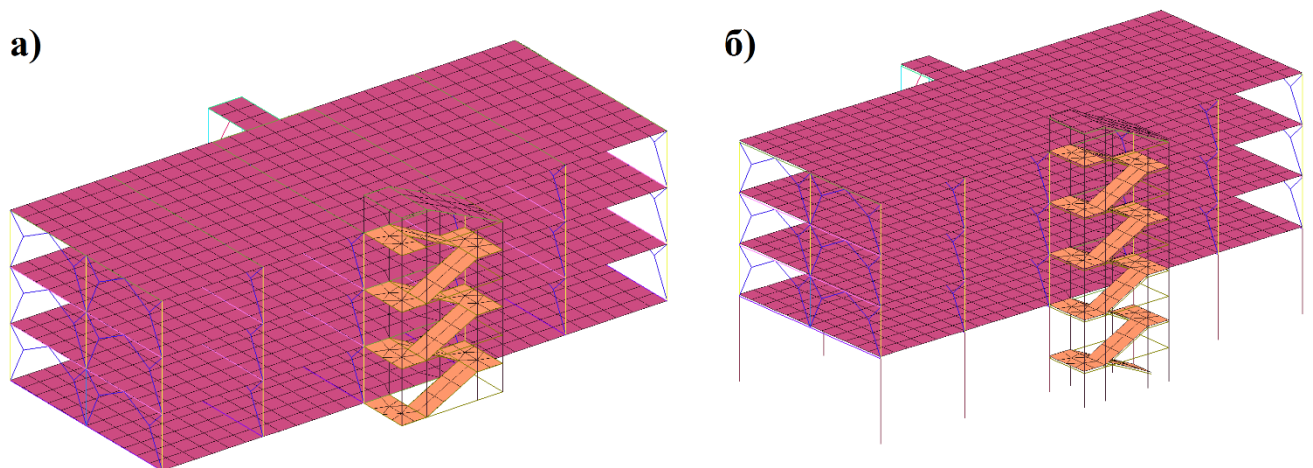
Расчетные схемы: а) отдельно стоящее зданий; б) здание с открытым нижним этажом
